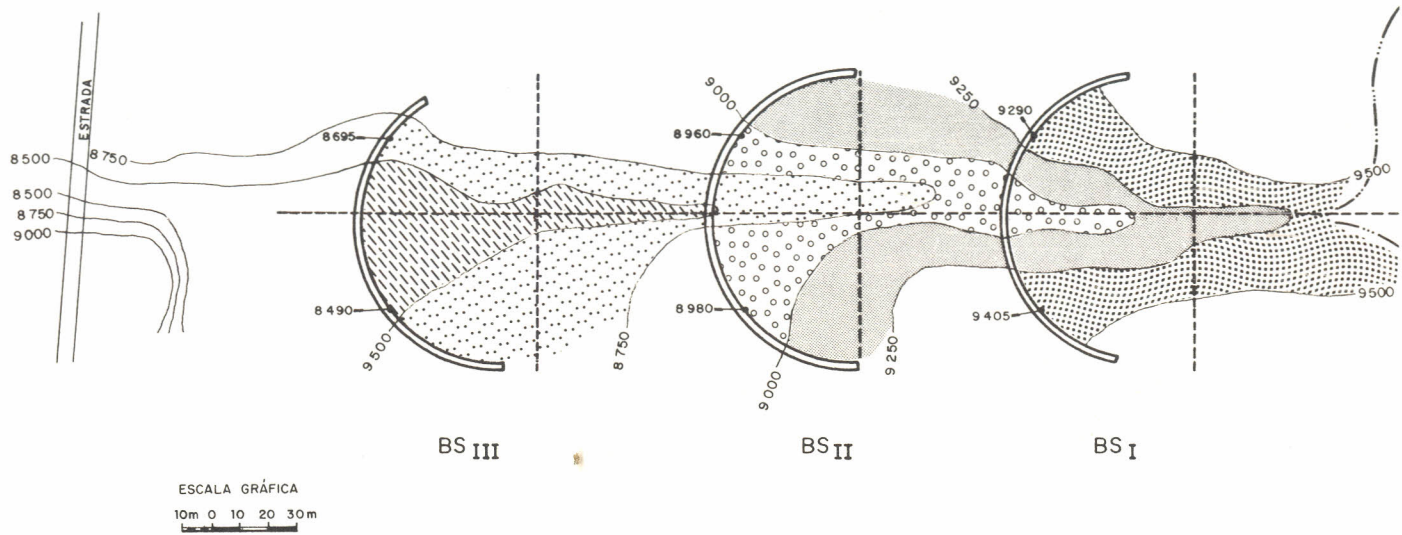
Planta planialtimétrica das barragens subterrâneas tipo CPATSA (SAES-BS).
